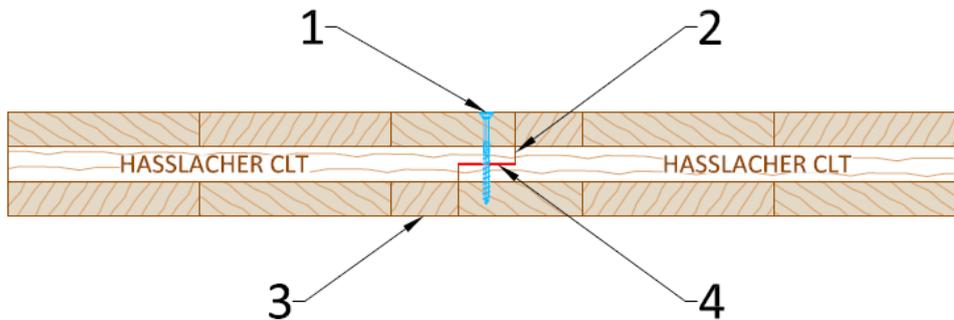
Coupe horizontale, jonction de murs, assemblage à mi-bois
